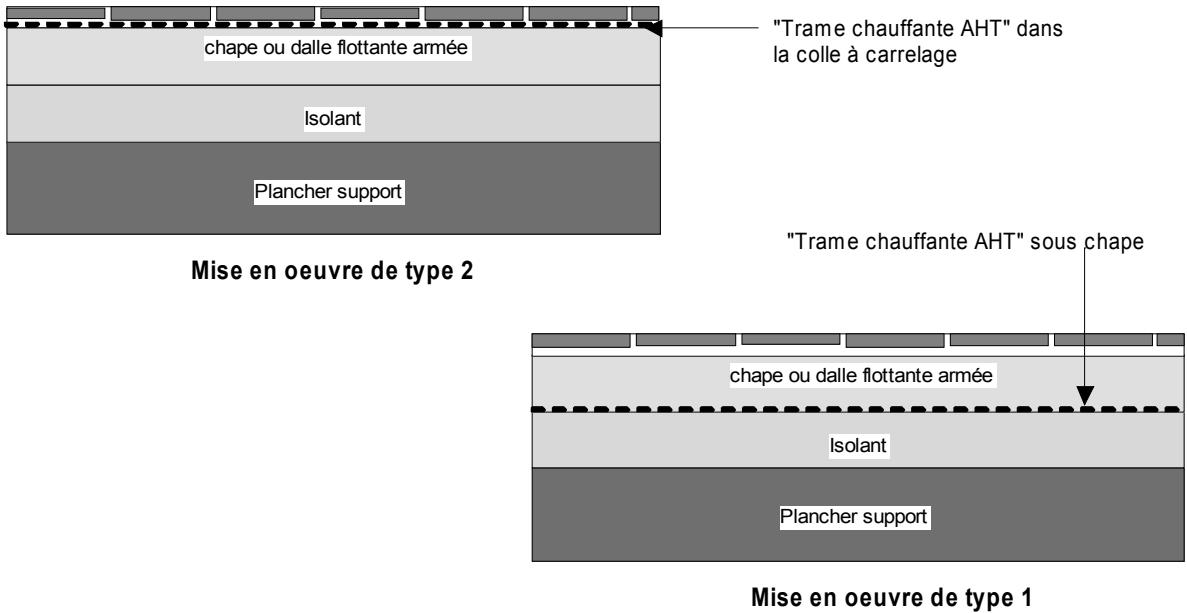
Schéma de principe du plancher chauffant (vue en coupe)
